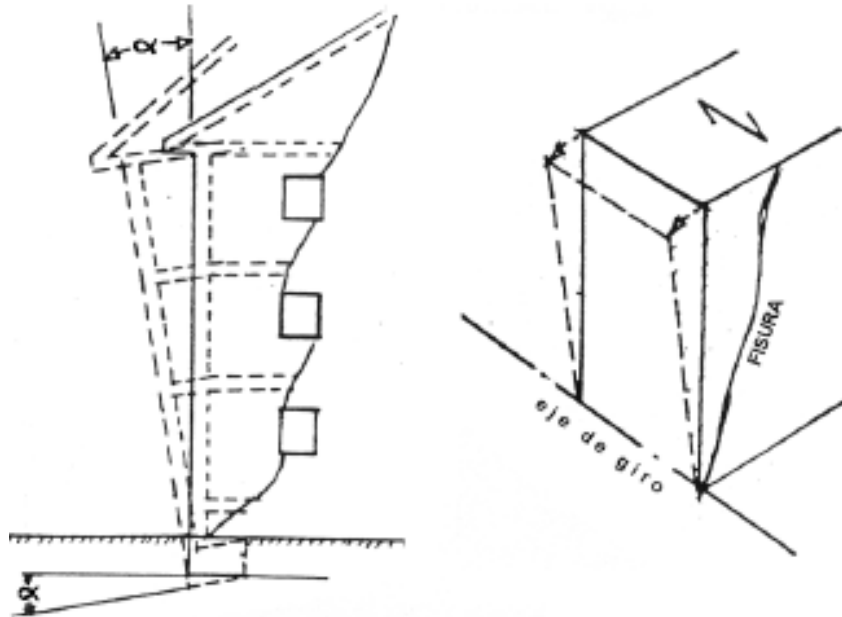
Agrietamiento de fachada por giro. (Rodríguez, 2004, pág. 36)
